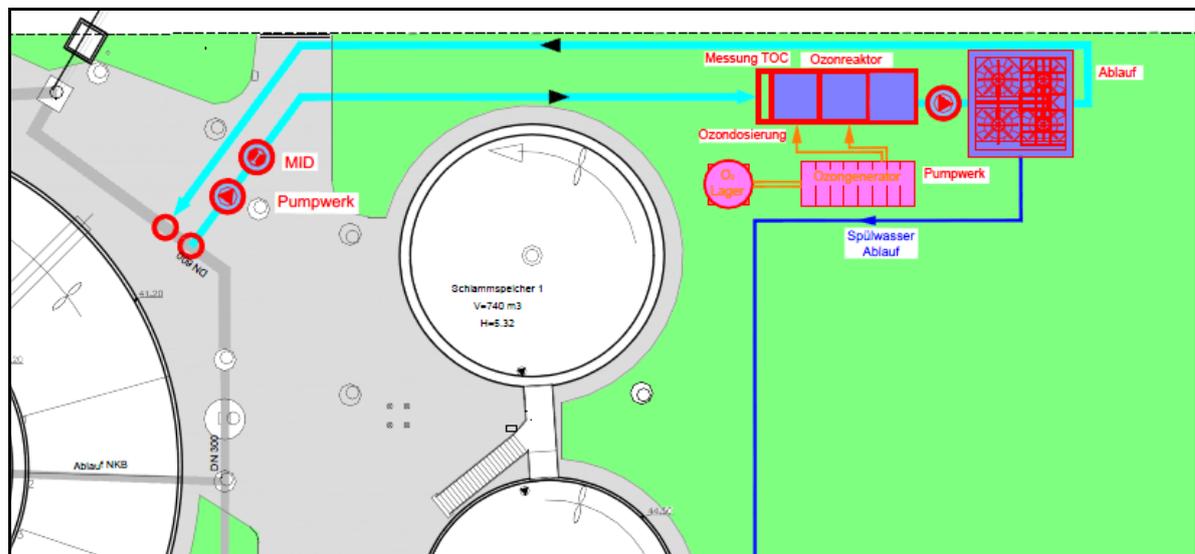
Lageplan KA Rahden - Variante 3.2 – Ozonung mit nachgeschalteter Dyna-Sand Filtration
